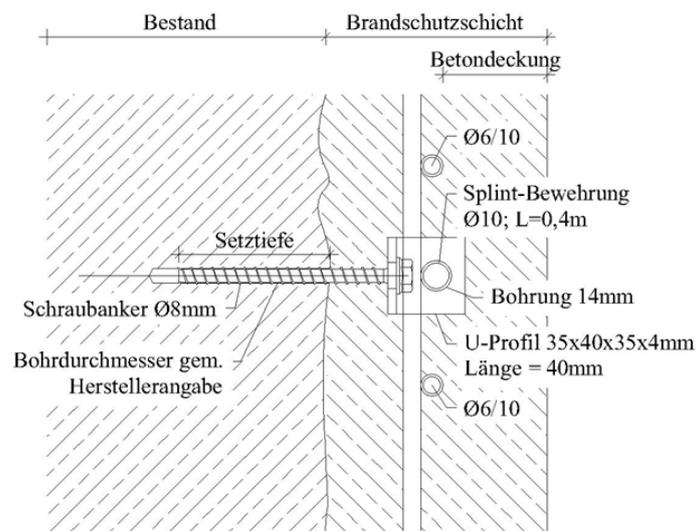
Beispielhaftes Befestigungsdetail aus [RL] einer Bewehrungsmatte mit Schraubanker
